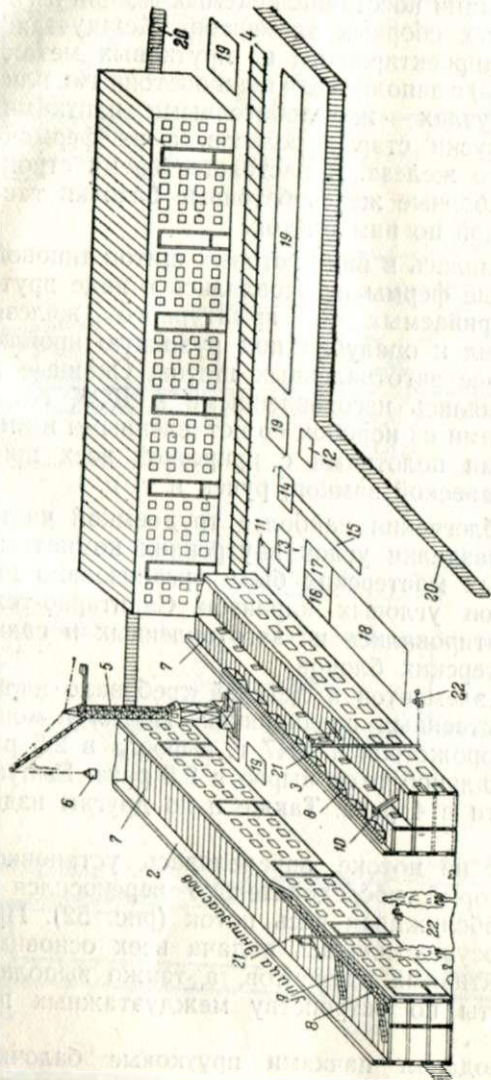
Схема организации работ по восстановлению домов № 28, 26 и 25. 1 — восстанавливаемый дом № 28; 2 — устанавливаемый дом № 26; 3 — восстанавливаемый дом № 25; 4 — пути башенного крана; 5 — башенный кран; 6 — контейнер; 7 — приямная площадка для грунтовых материалов; 8 — звеной транспортер; 9 — рольганг; 10 — лоток для снука для изготовления штукатурного раствора; 11 — растворомешалка для изготовления кладочного раствора; 12 — компрессор; 13 — растворомешалка для приготовления кладочного раствора; 14 — транспортёр; 15 — склад известня; 16 — склад цемента; 17 — склад песка; 18 — склад известня; 19 — склад строительных материалов; 20 — забор; 21 — край-укосина; 22 — лебедка с мотором
